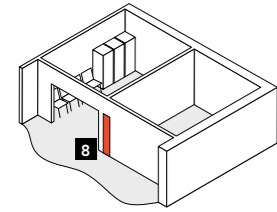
Схема дополнительных элементов при сложных планировочных решениях помещений.
